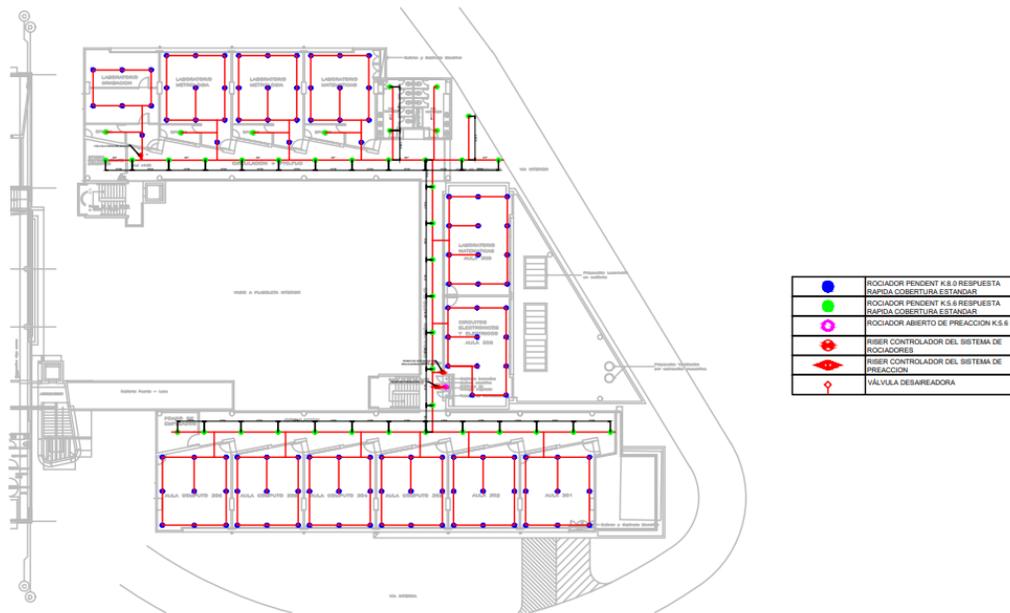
Plano en malla piso 3. Elaboración propia.
